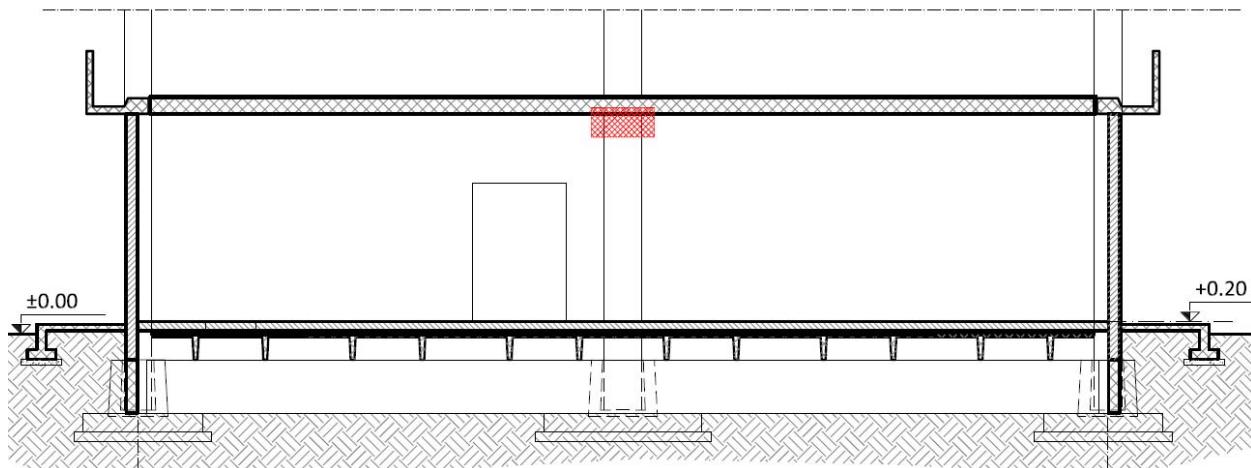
Intervento 10 – Individuazione in sezione dell'intervento
